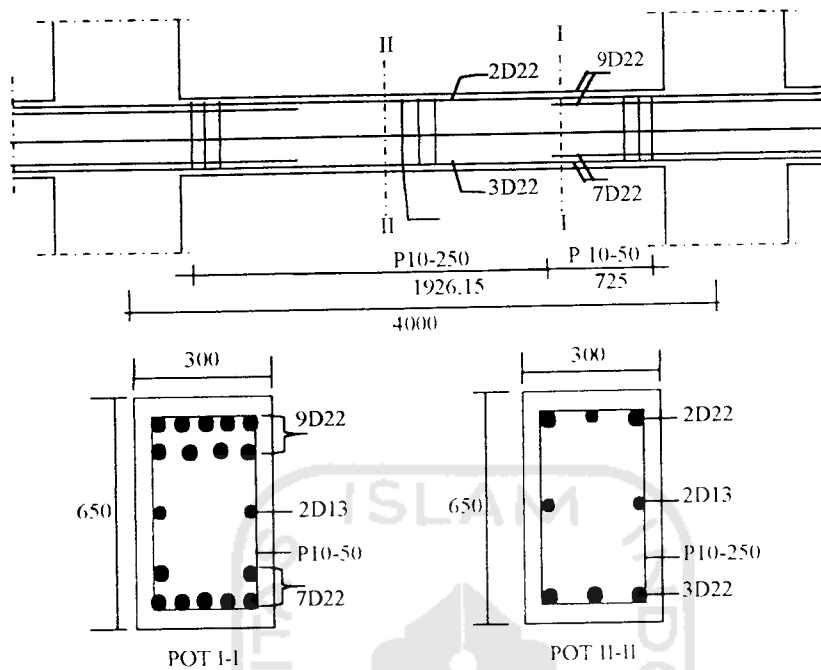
Balok Portal E Bentang 4 m Lantai 3
